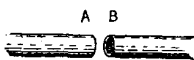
Soudure de deux tuyaux de plomb.
